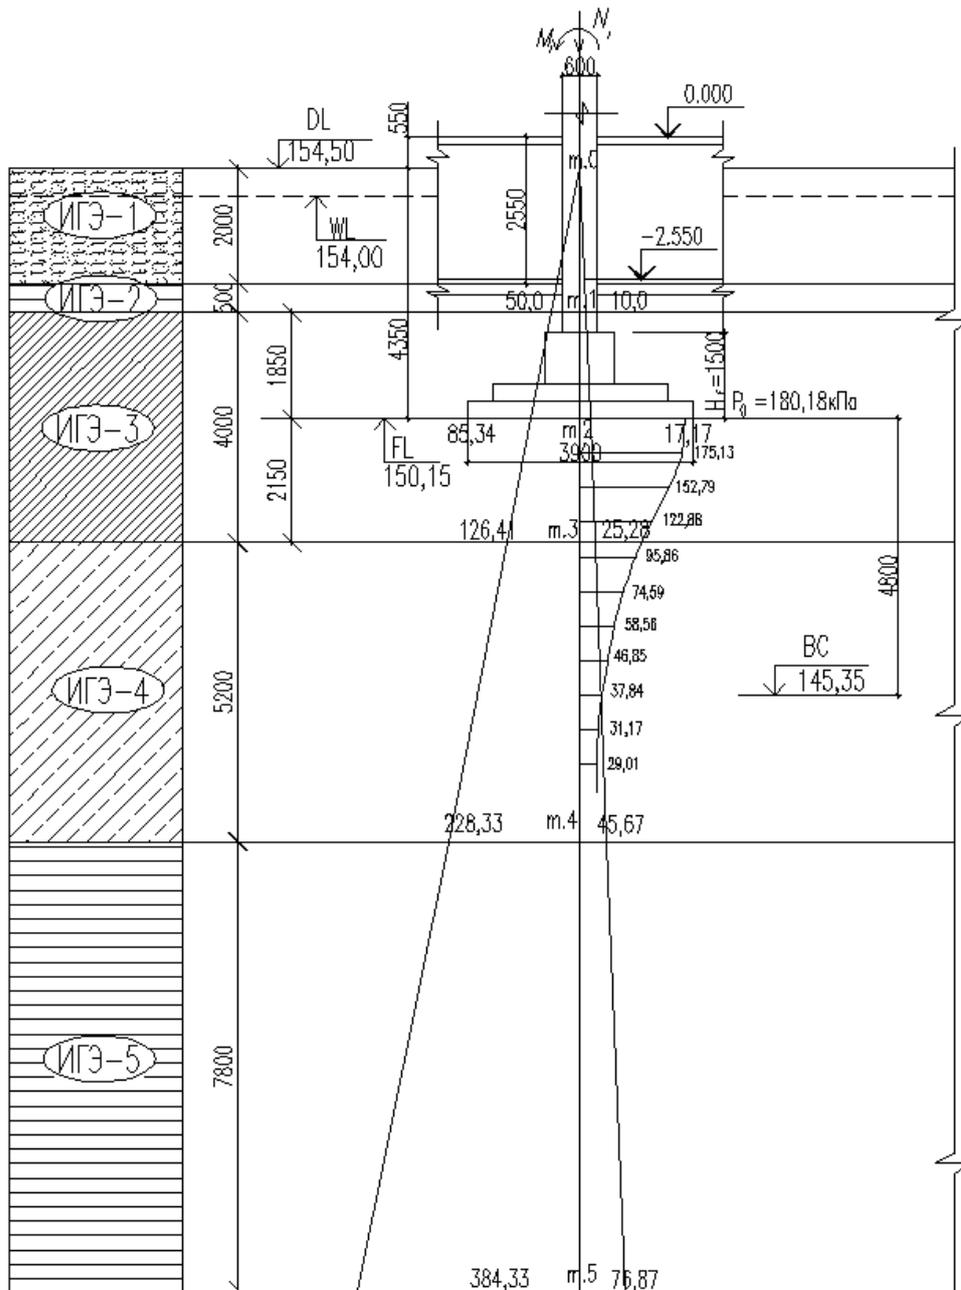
До розрахунку осідання фундаменту ФМЗ-1 в перерізі I - I.
